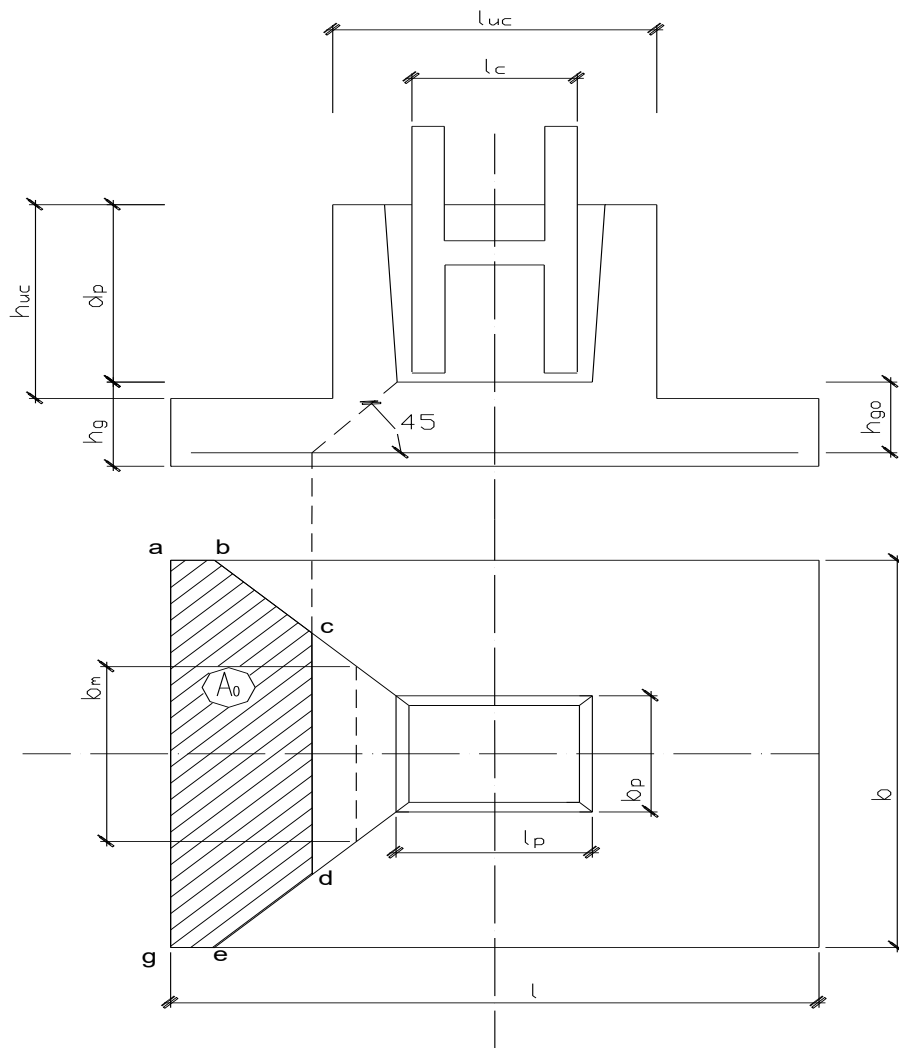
Схема к расчету фундамента на продавливание дна стакана колонной
